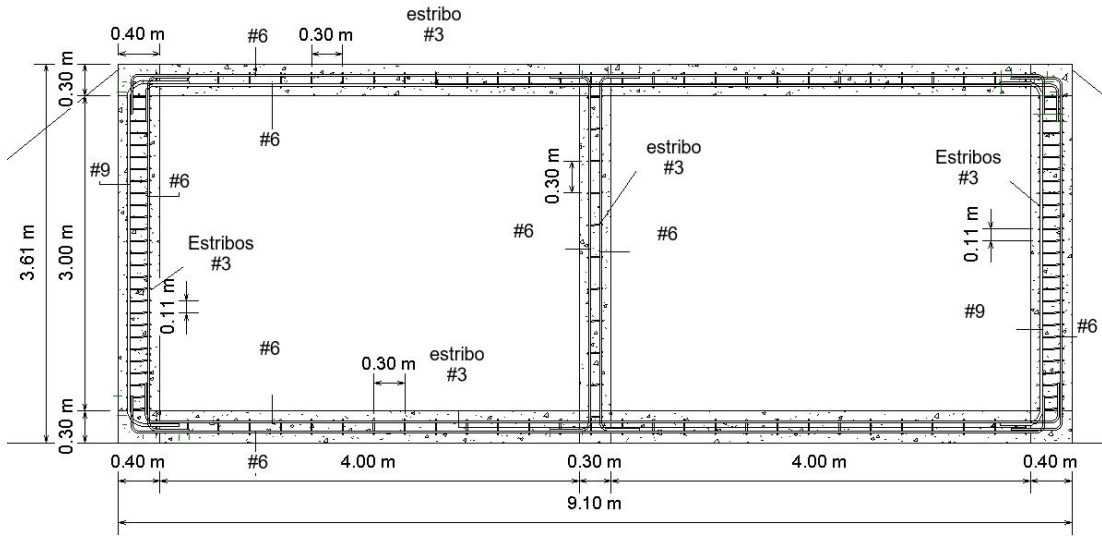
Vista en sección de la entrada de la alcantarilla con caudal para método teórico.
